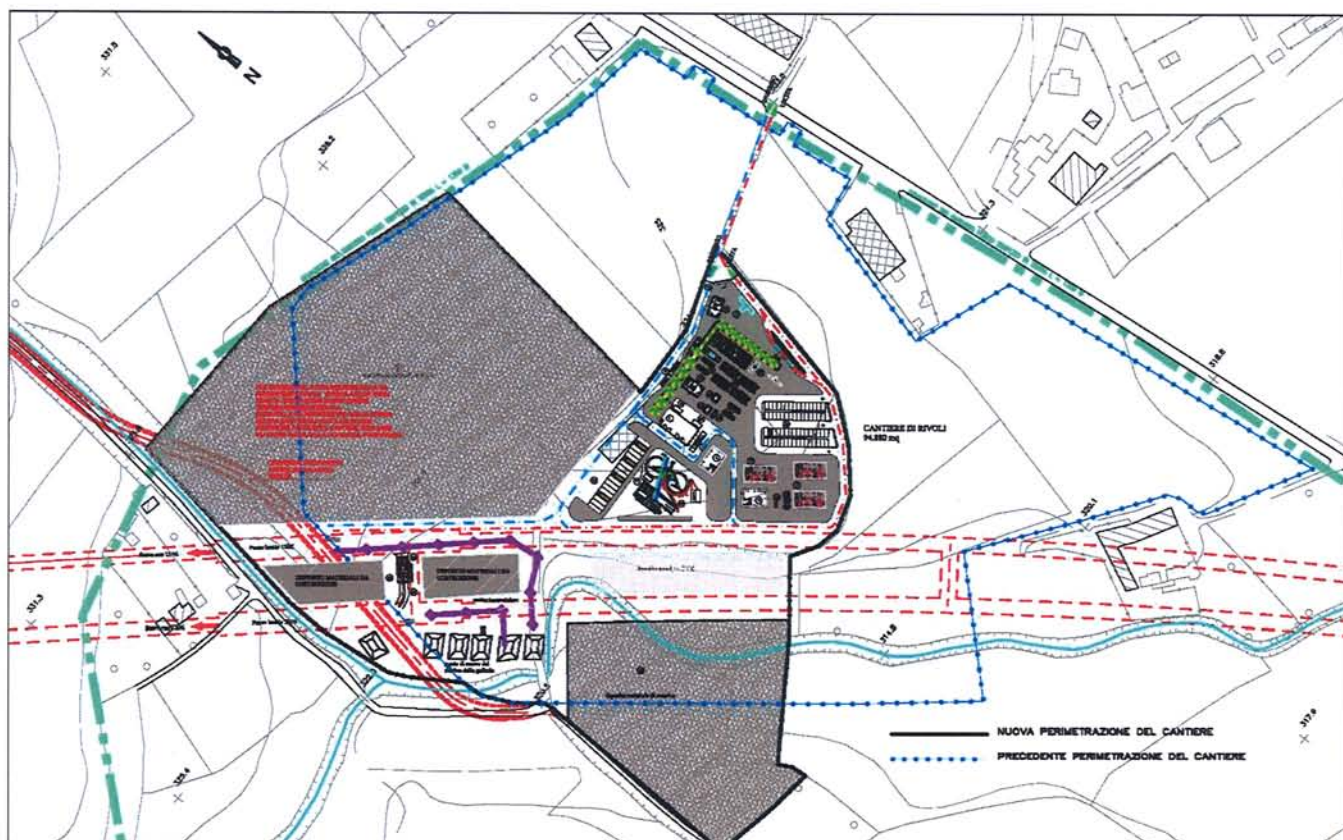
Stralcio planimetrico del cantiere di Rivoli "ridotto"– Scenario alternativo
